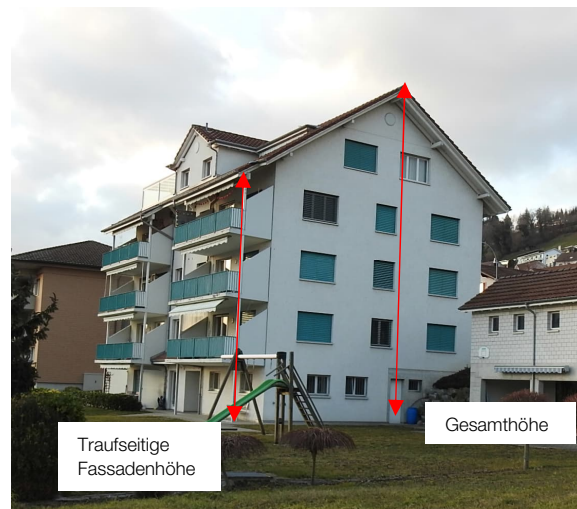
Beispiel Gesamt- und Fassadenhöhe
